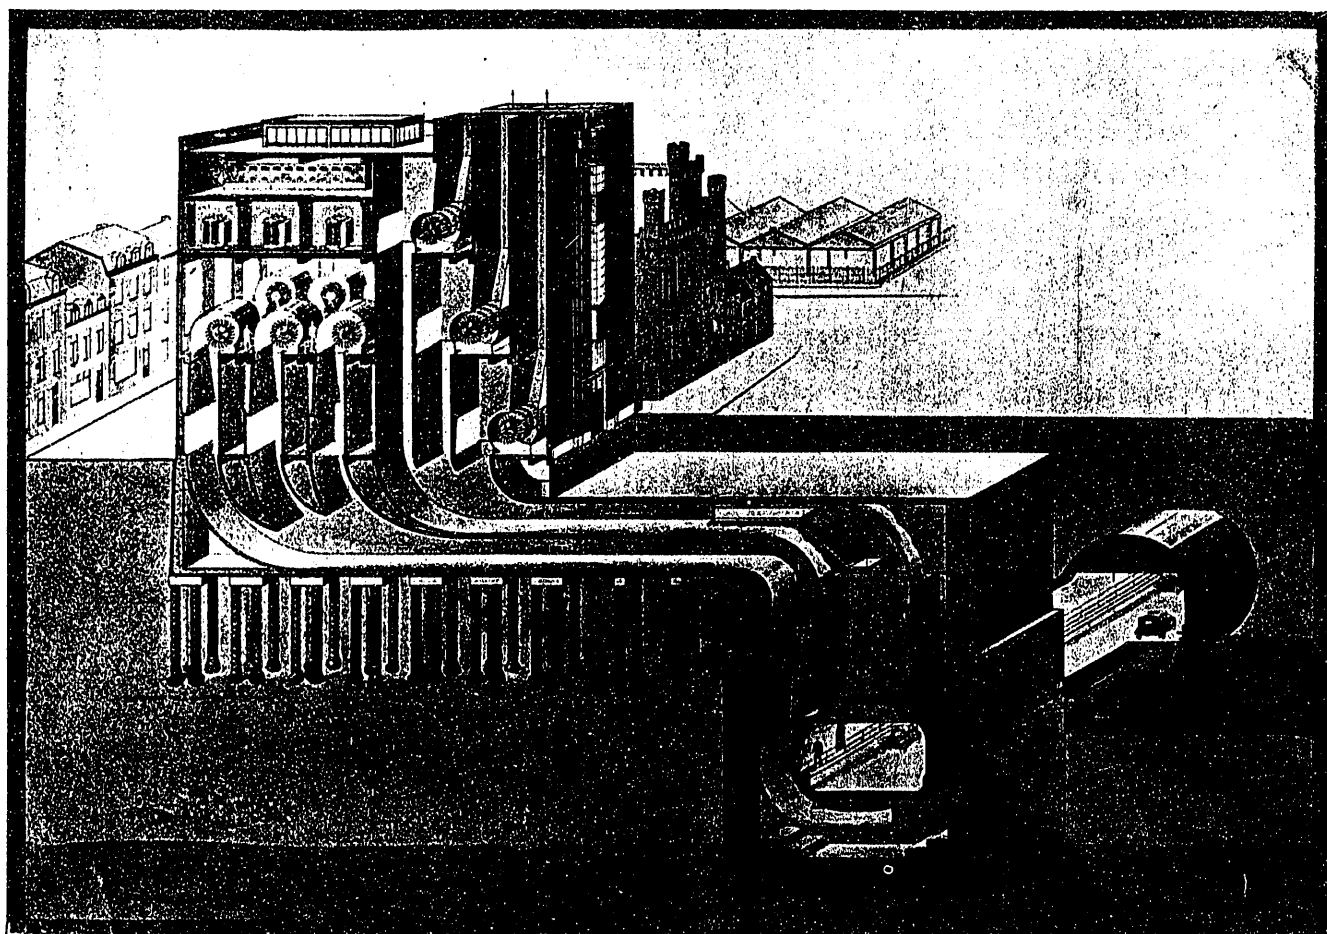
Sección del pabellón de ventilación, pozo de ventilación y túnel
